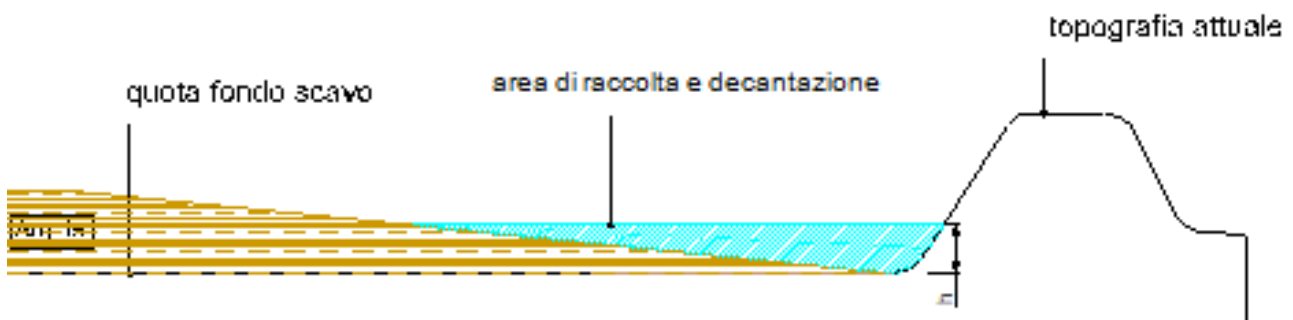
Sezione tipo dell'area di raccolta e decantazione.
